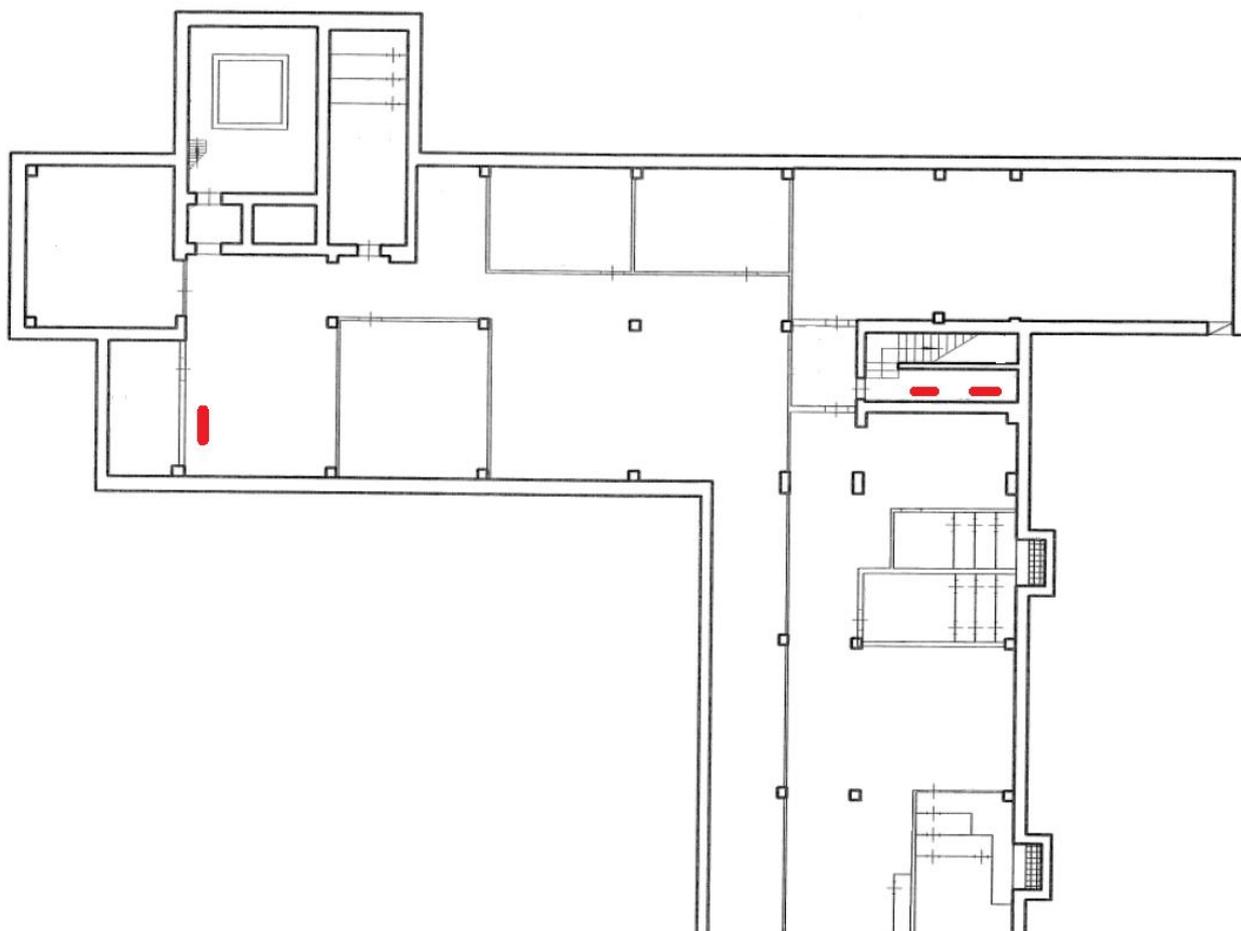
План обследуемого подвального помещения с указанием размещения газовых баллонов
